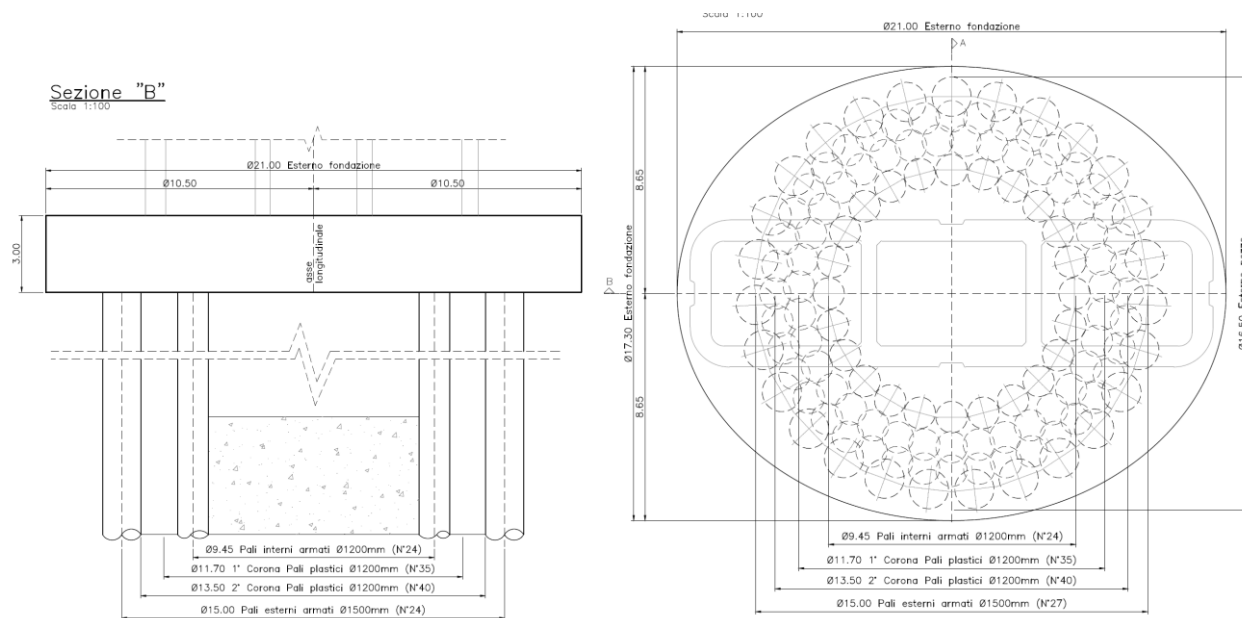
stralcio carpenteria fondazione con pozzo di fondazione ellittico di diametro 13.7 x 21m
